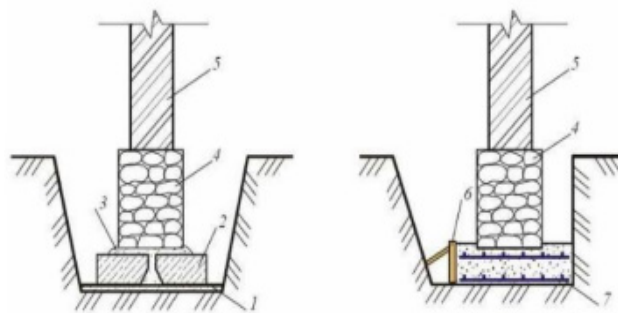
Уширение подошвы фундамента: 1-уплотненная грунтовая подготовка; 2-железобетонные плиты; 3-цементно-песчаный раствор; 4-фундамент; 5-стена; 6-опалубка; 7-арматурная сетка.
